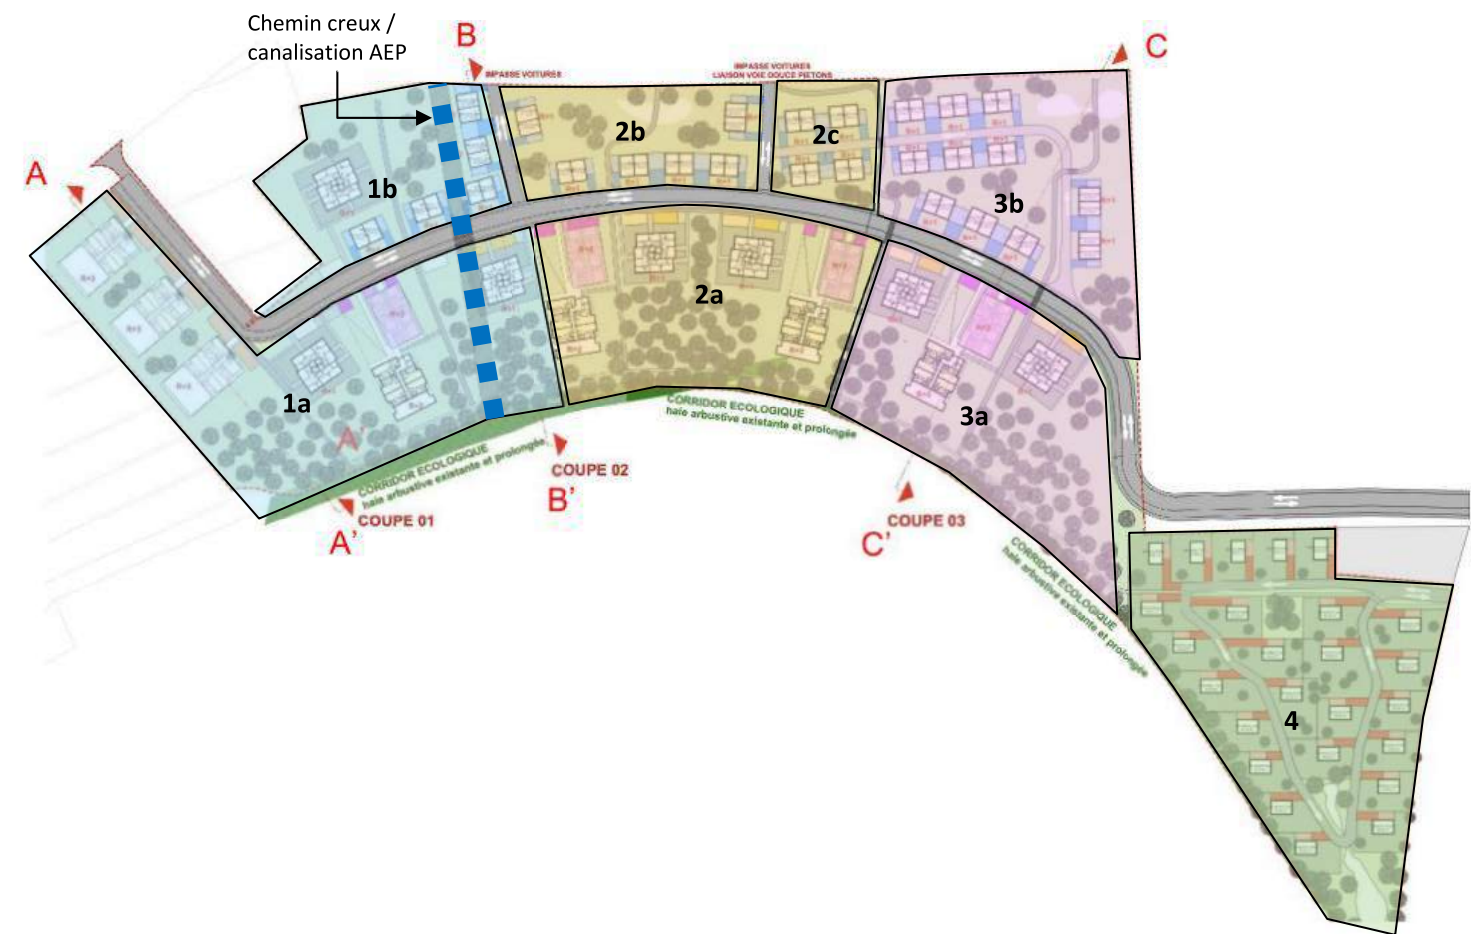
Plan des lots de la ZAC (Source : COGEDIM)
